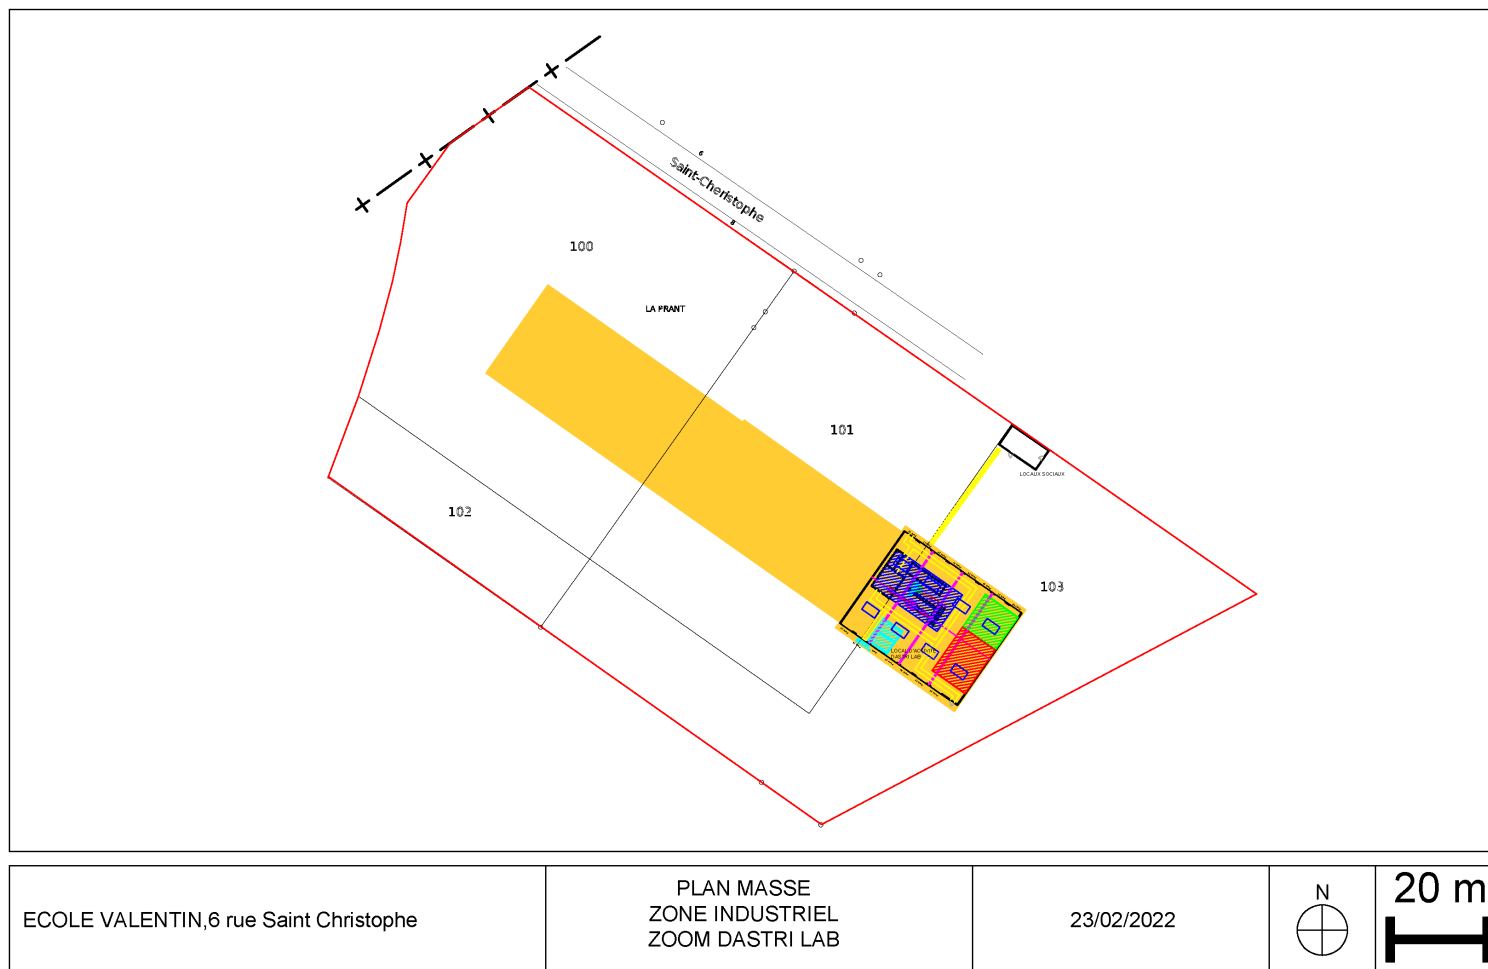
Plan de masse DASTRI LAB - parcelles cadastrales d'implantation
